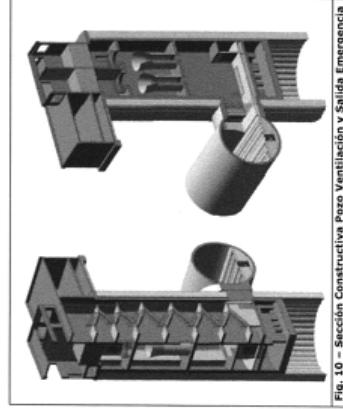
Sección Constructiva Pozo Ventilación y Salida Emergencia
